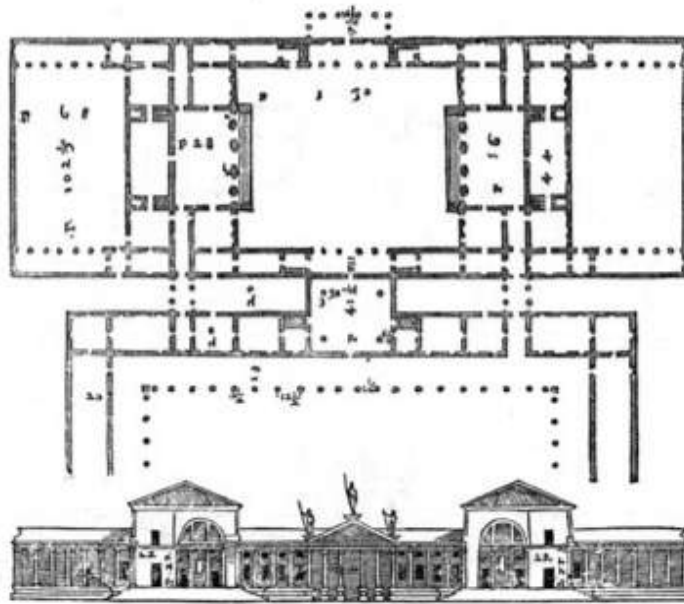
Planta y fachada de la villa Thiene, según aparece en la página 64 de la primera edición del libro de Palladio, publicada en Venecia en 1570.
